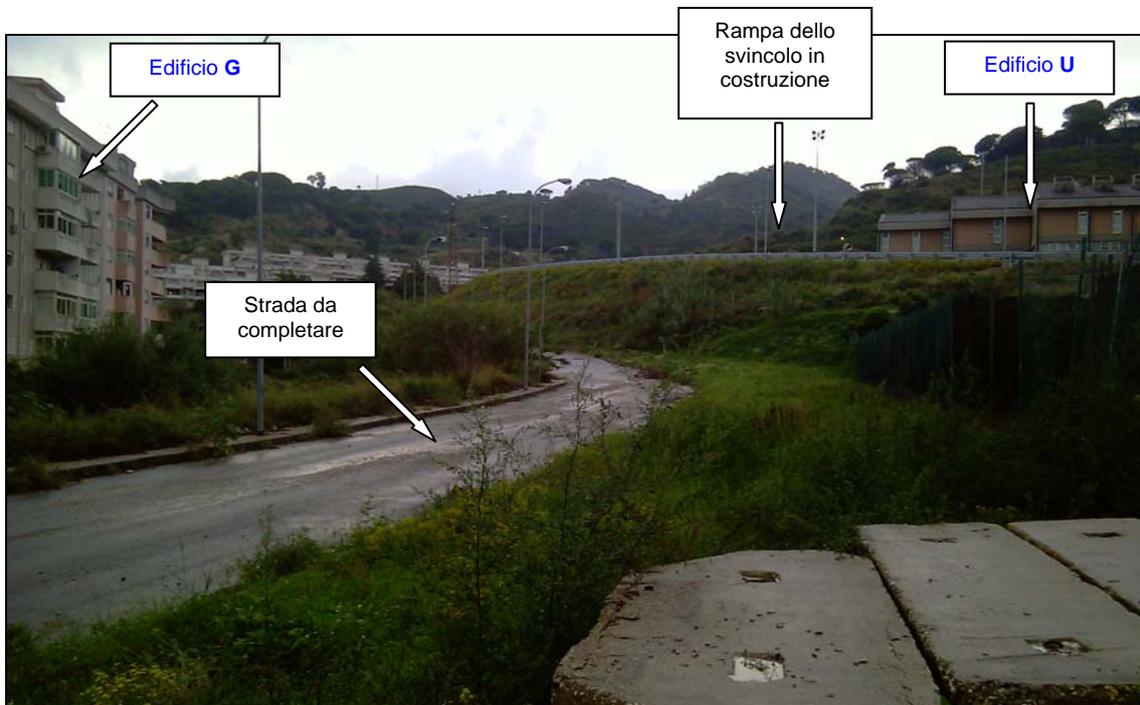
Punto finale dell'intervento infrastrutturale in ipotesi: muro sormontato dalla ringhiera gialla
